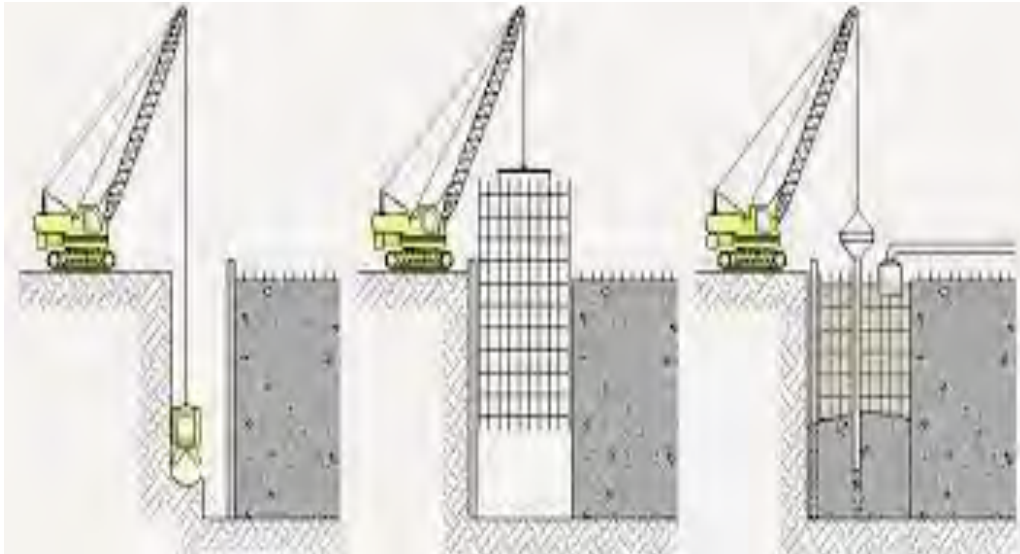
Proceso constructivo de un muro pantalla. Fuente:
